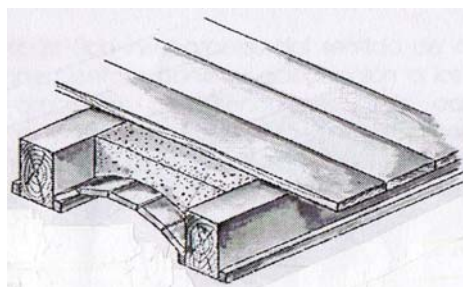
Forjado con bóvedas de cañón entre viguetas de madera.
